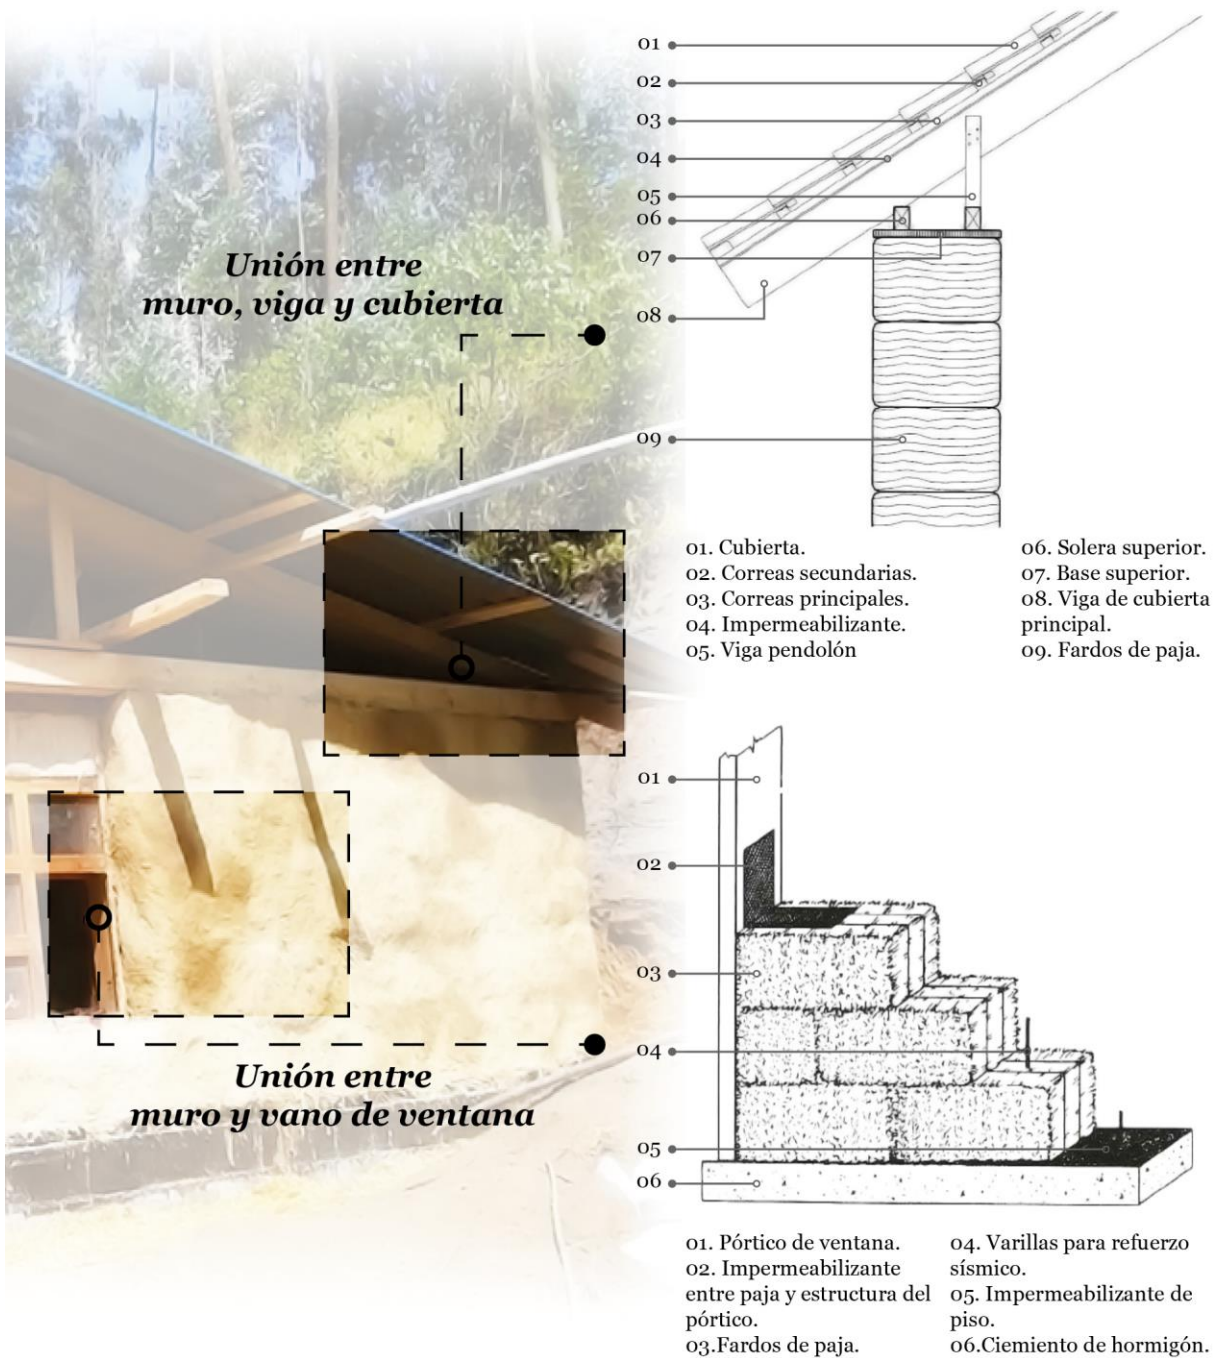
Detalles de uniones de muro, vanos y cubierta.
